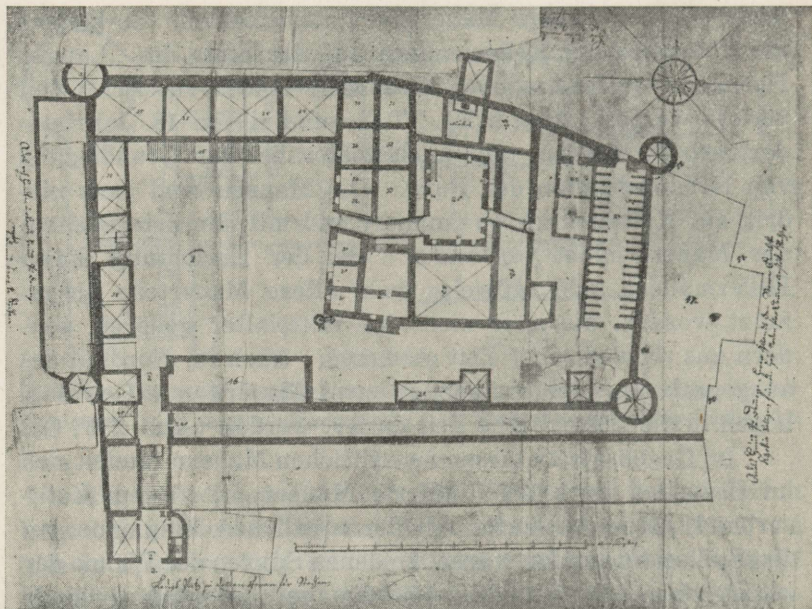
Das Schloss im Jahre 1683 (G. Dryander's Plan im schwedischen Kriegsarchiv, Stockholm).
